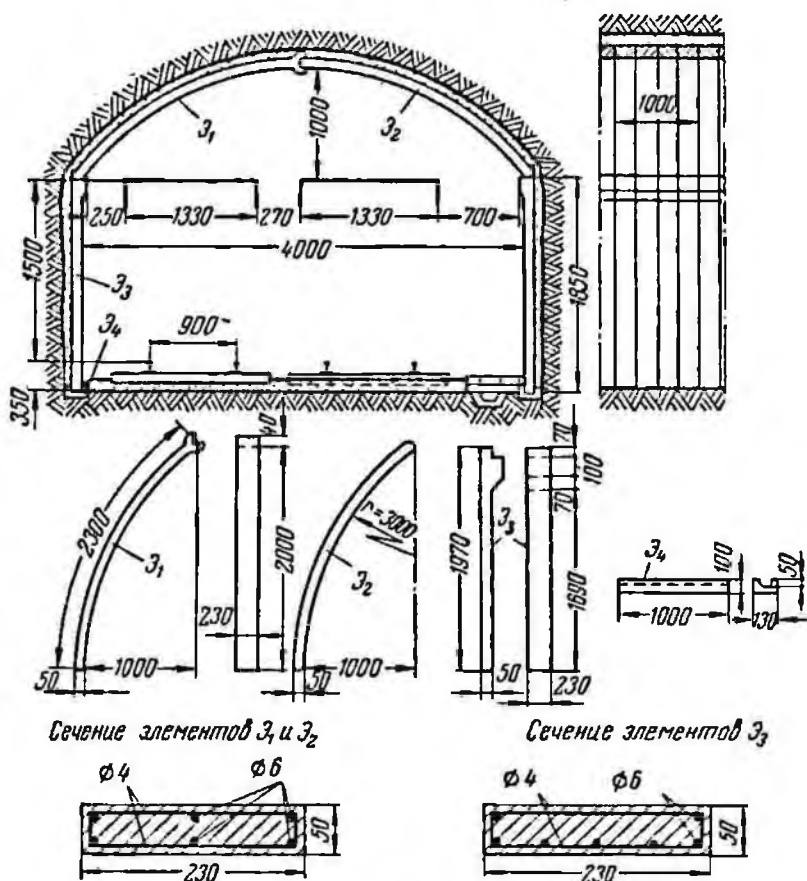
Тонкостенная арочная гладкая сборная железобетонная крепь ТАГ-I
